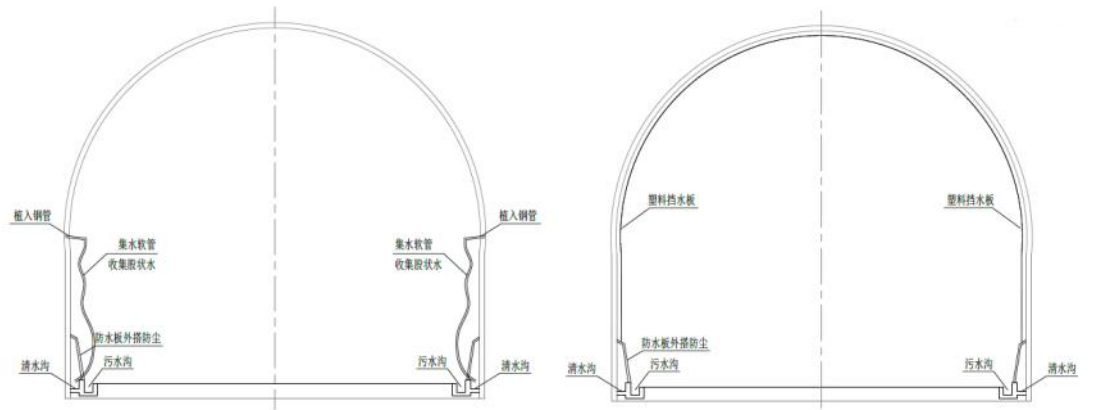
钻爆法顺坡初支段清污分流横断面图
